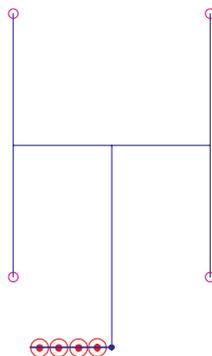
Пример разводки на 4 насадка в помещении квадратной (прямоугольной) формы
